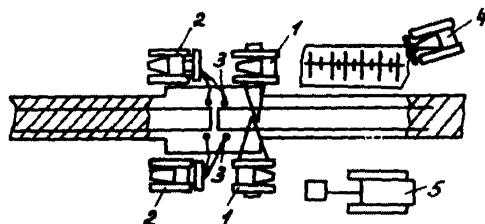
Схема заварки захлеста или сварки катушки:
